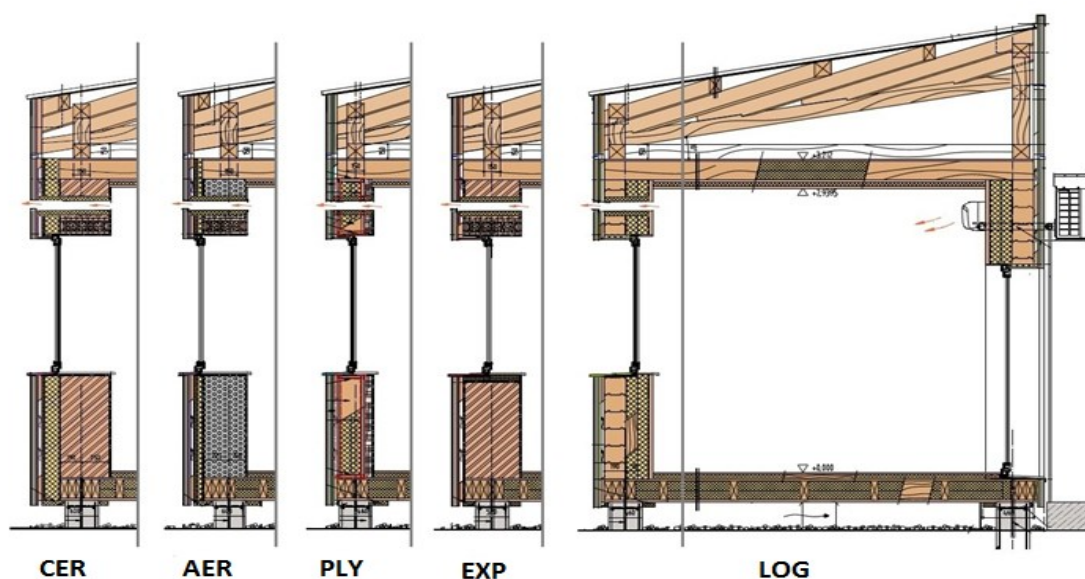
Продольный разрез тестовых зданий из различных строительных материалов
